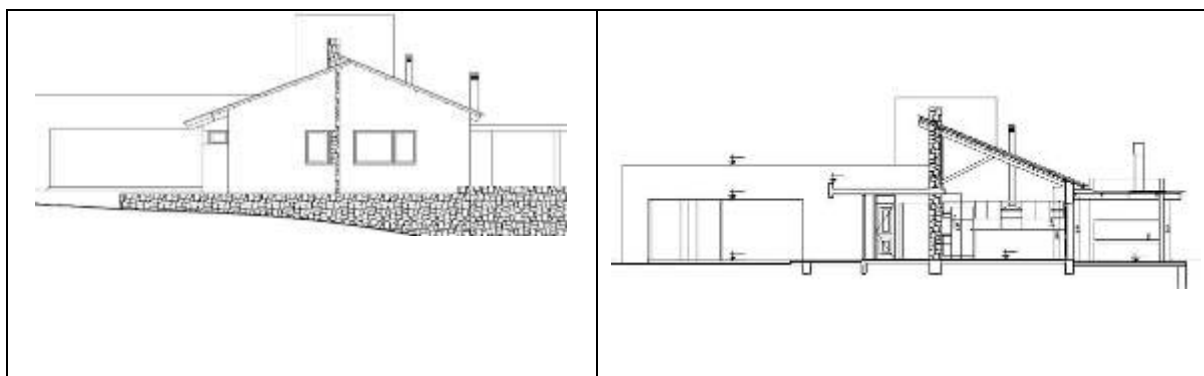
y 16: Fachada Nor-Este - Corte Sureste – Noroeste (Sector comedor – galería)
